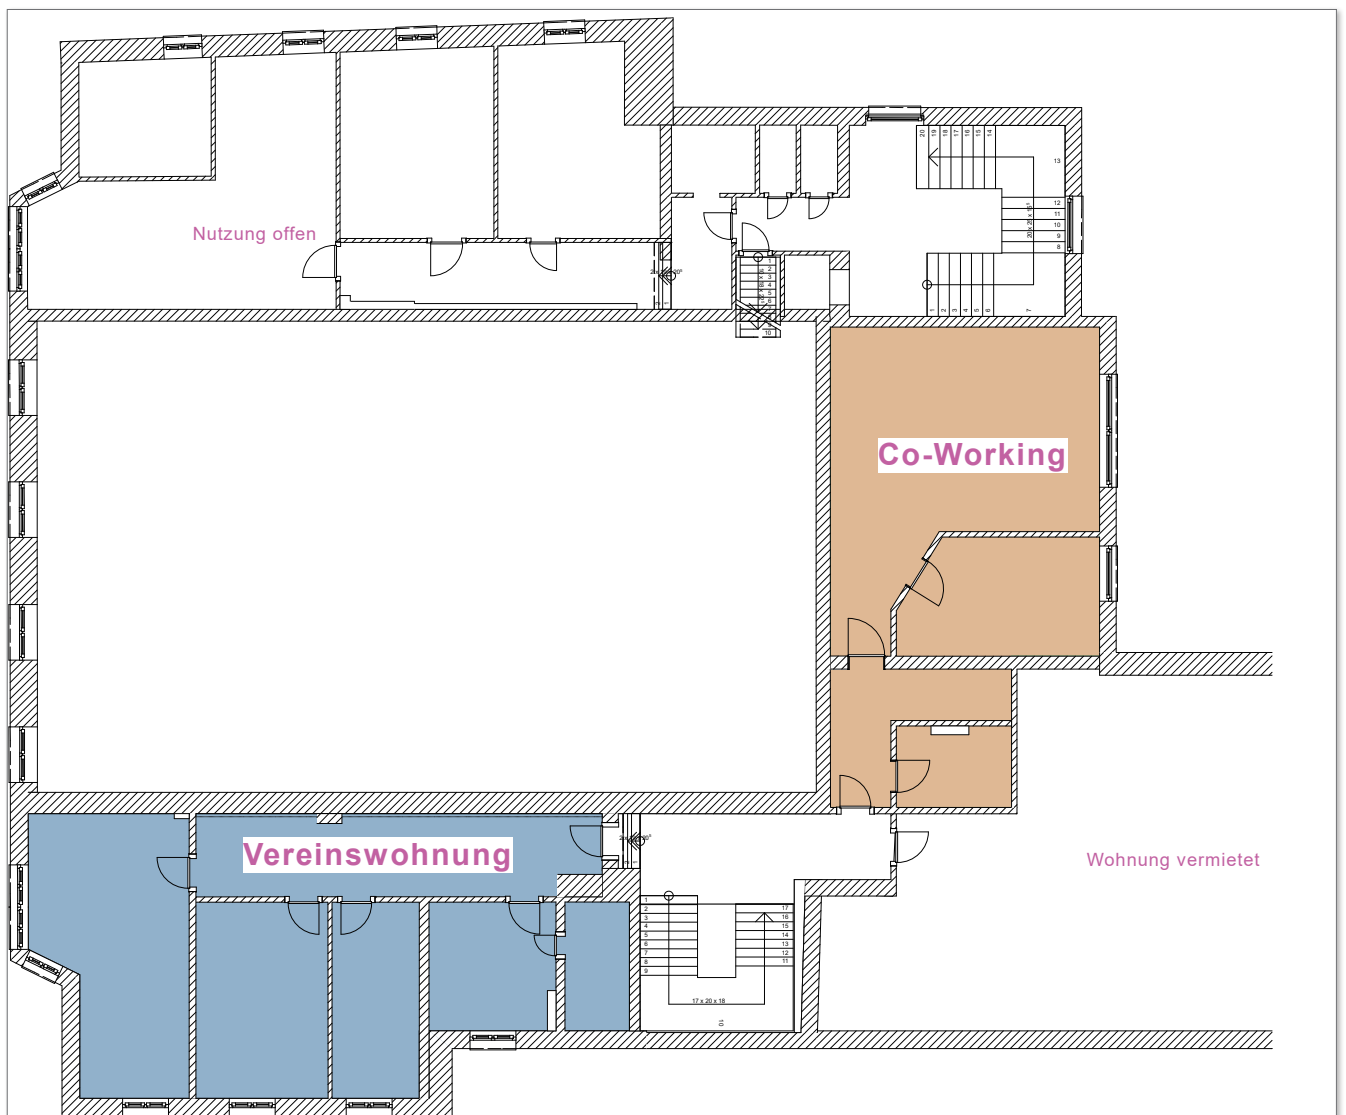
Grundriss 2. Obergeschoss - Nutzungskonzept Altes Lehngericht (M14), Darstellung Esther Gerstenberg
